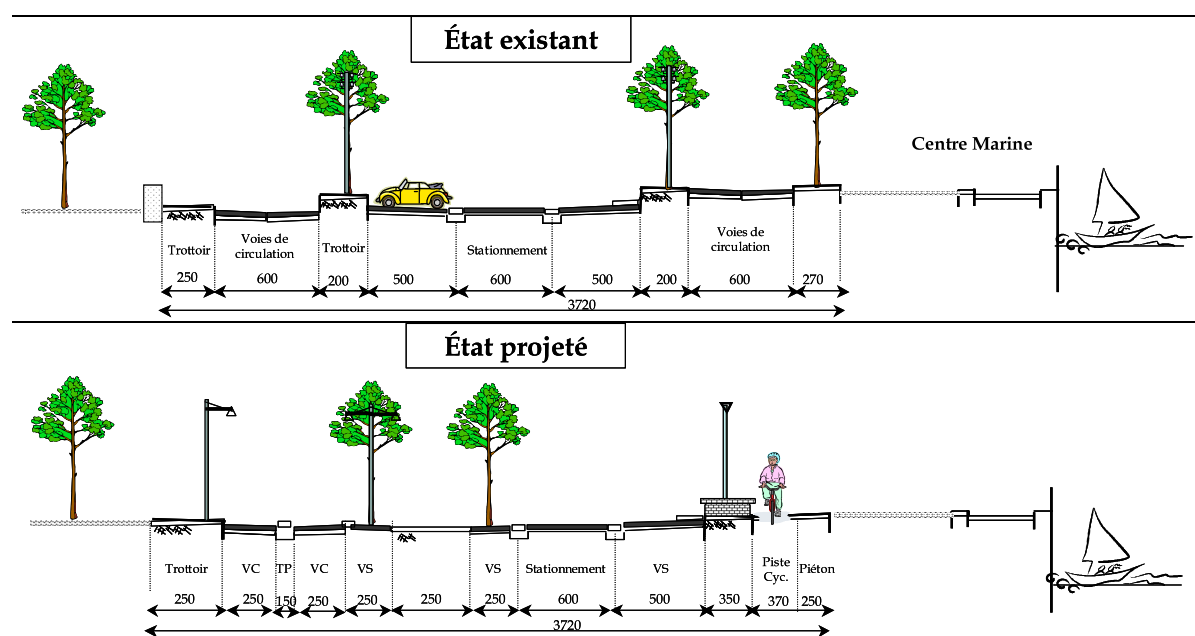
21. Coupe transversale de l'emprise (états existant et projeté)
